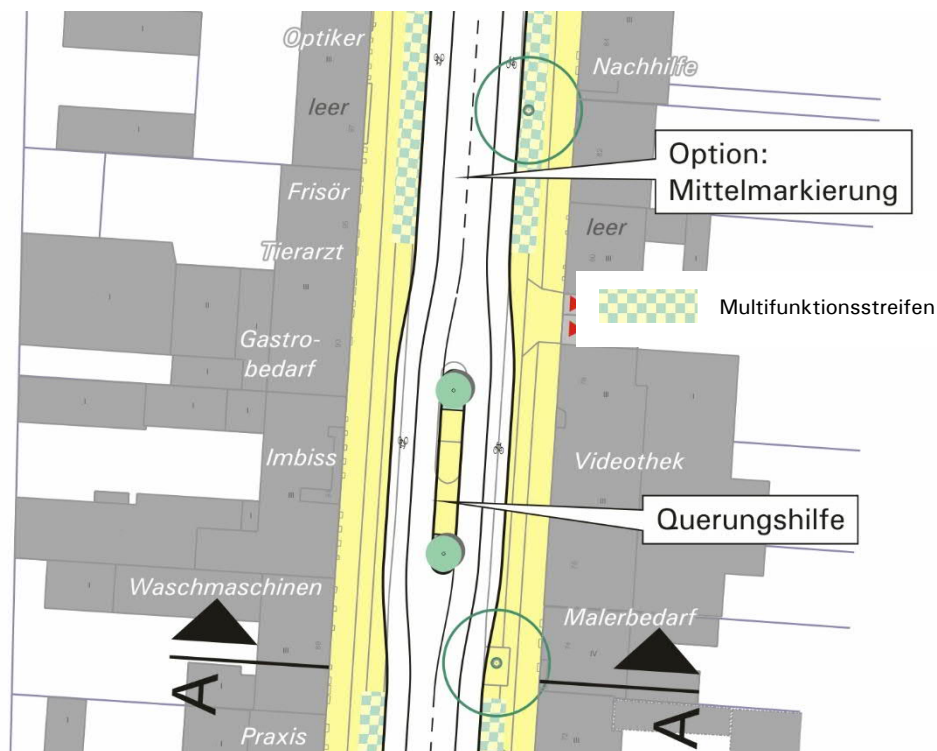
Lageplanausschnitt Urbaner Raum – Variante 2 Veloroute
